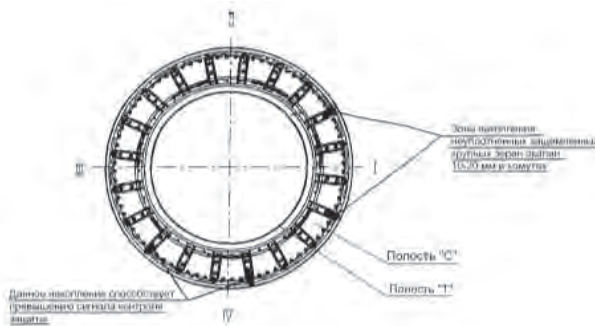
Схема дефектных мест в соединительных арматурных хомутах
